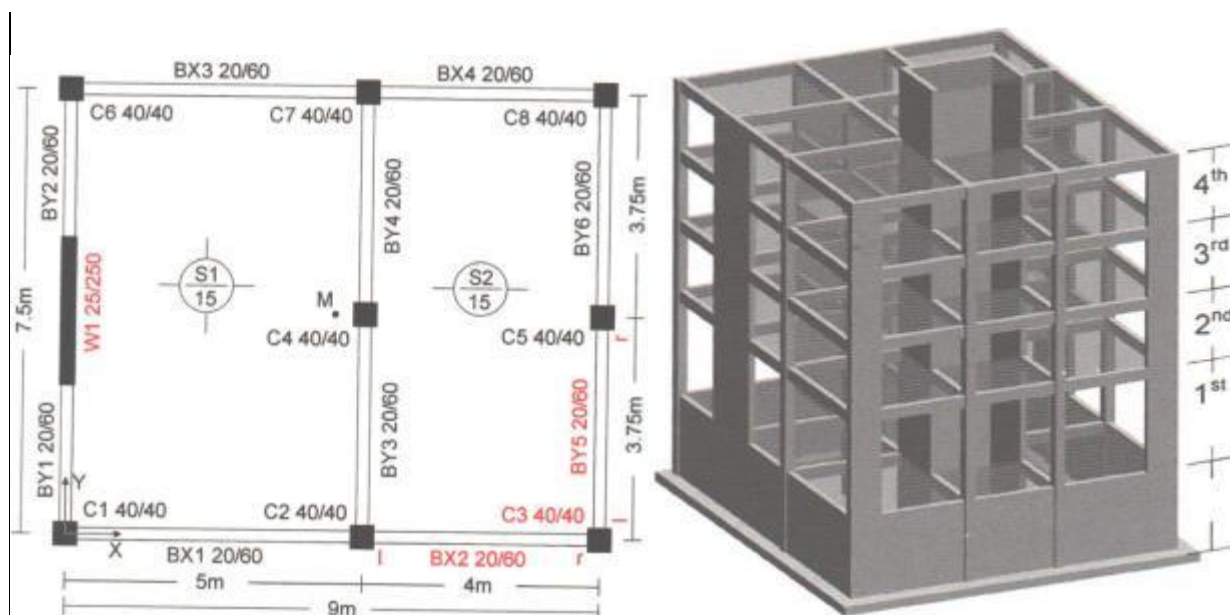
Способы усиления каркасного здания: а) одна вертикальная стена жесткости в плане; б) усиление стены первого этажа и устройство Т- и П-образных вертикальных диафрагм жесткости
